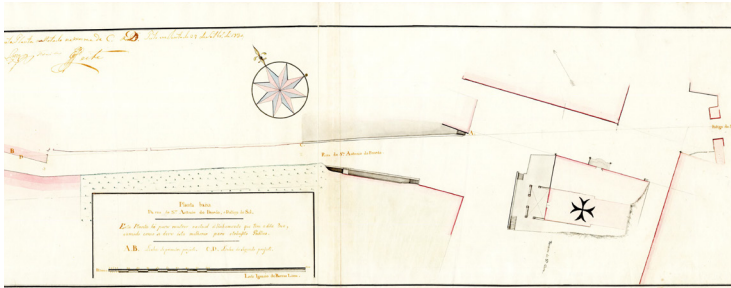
Planta baixa da Rua de Santo António do Penedo, e Postigo do Sol, aprov. Junta das Obras Públicas 1830.
